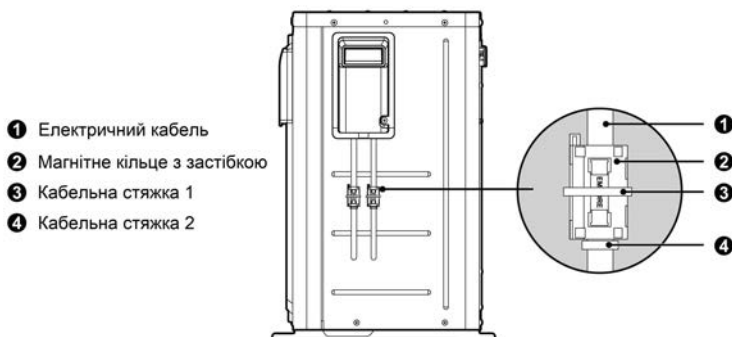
Схема зовнішньої проводки та кріплення
